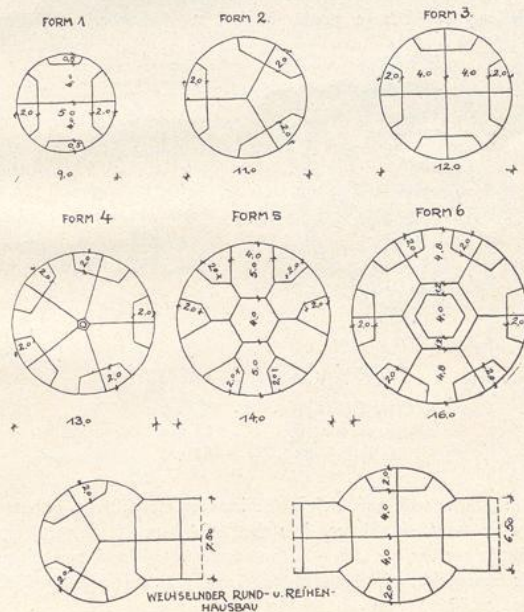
Schematische Darstellung von Grundrisslösungen beim Rundbau
